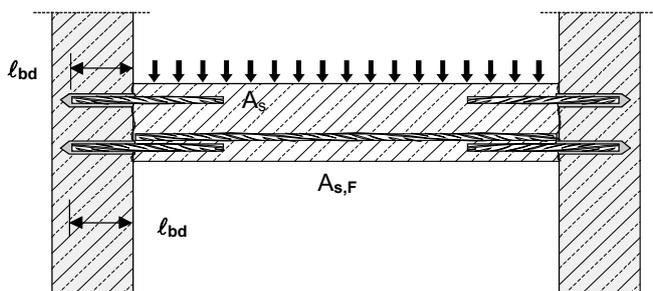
Ancrage direct d'armatures pour élément principalement en compression. Les armatures subissent une contrainte en compression.
